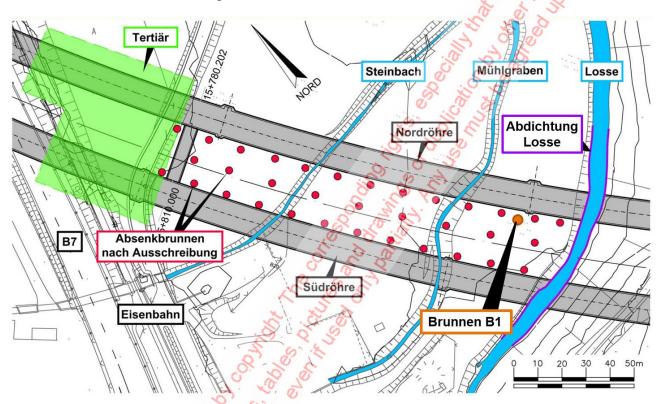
Tunnel Hirschhagen, Grundwasserabsenkung, Lageplan
